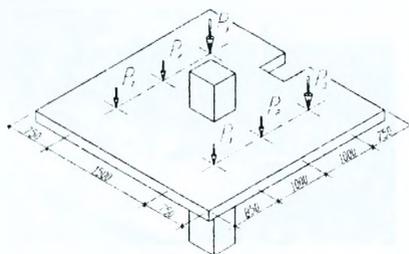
Схема эквивалентных нагрузок на плиту НП – 7
